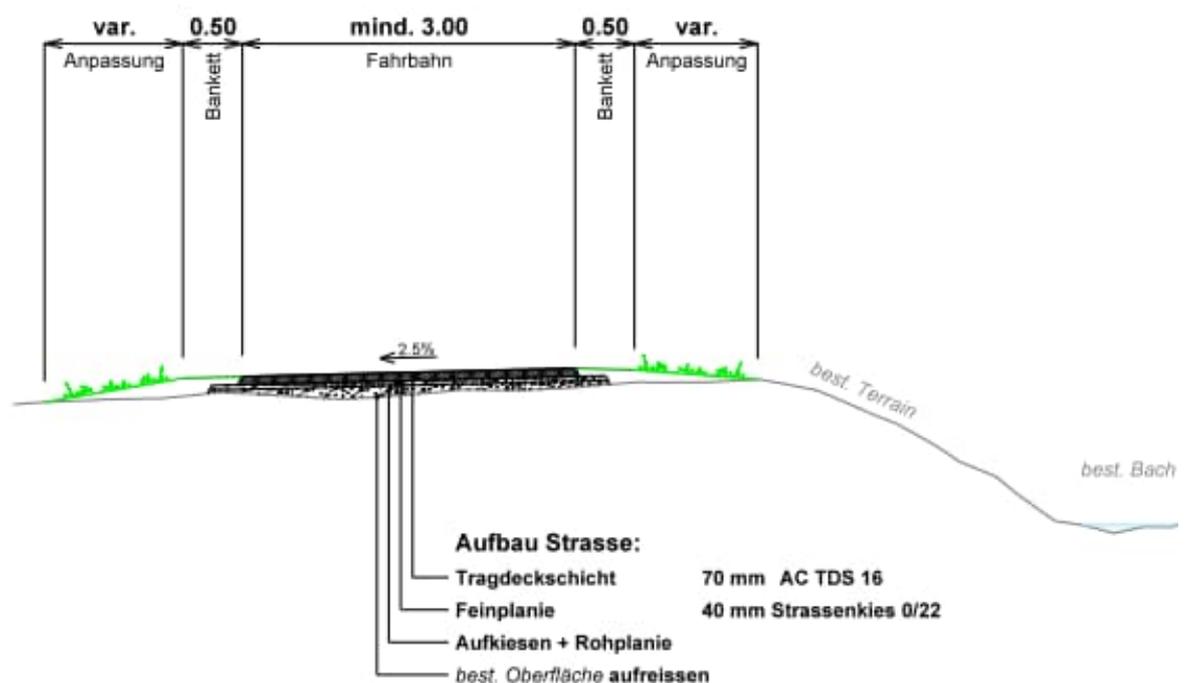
Ausschnitt Normalprofil Projektierte Erschliessungsstrasse, Plan Nr. 1357-013
